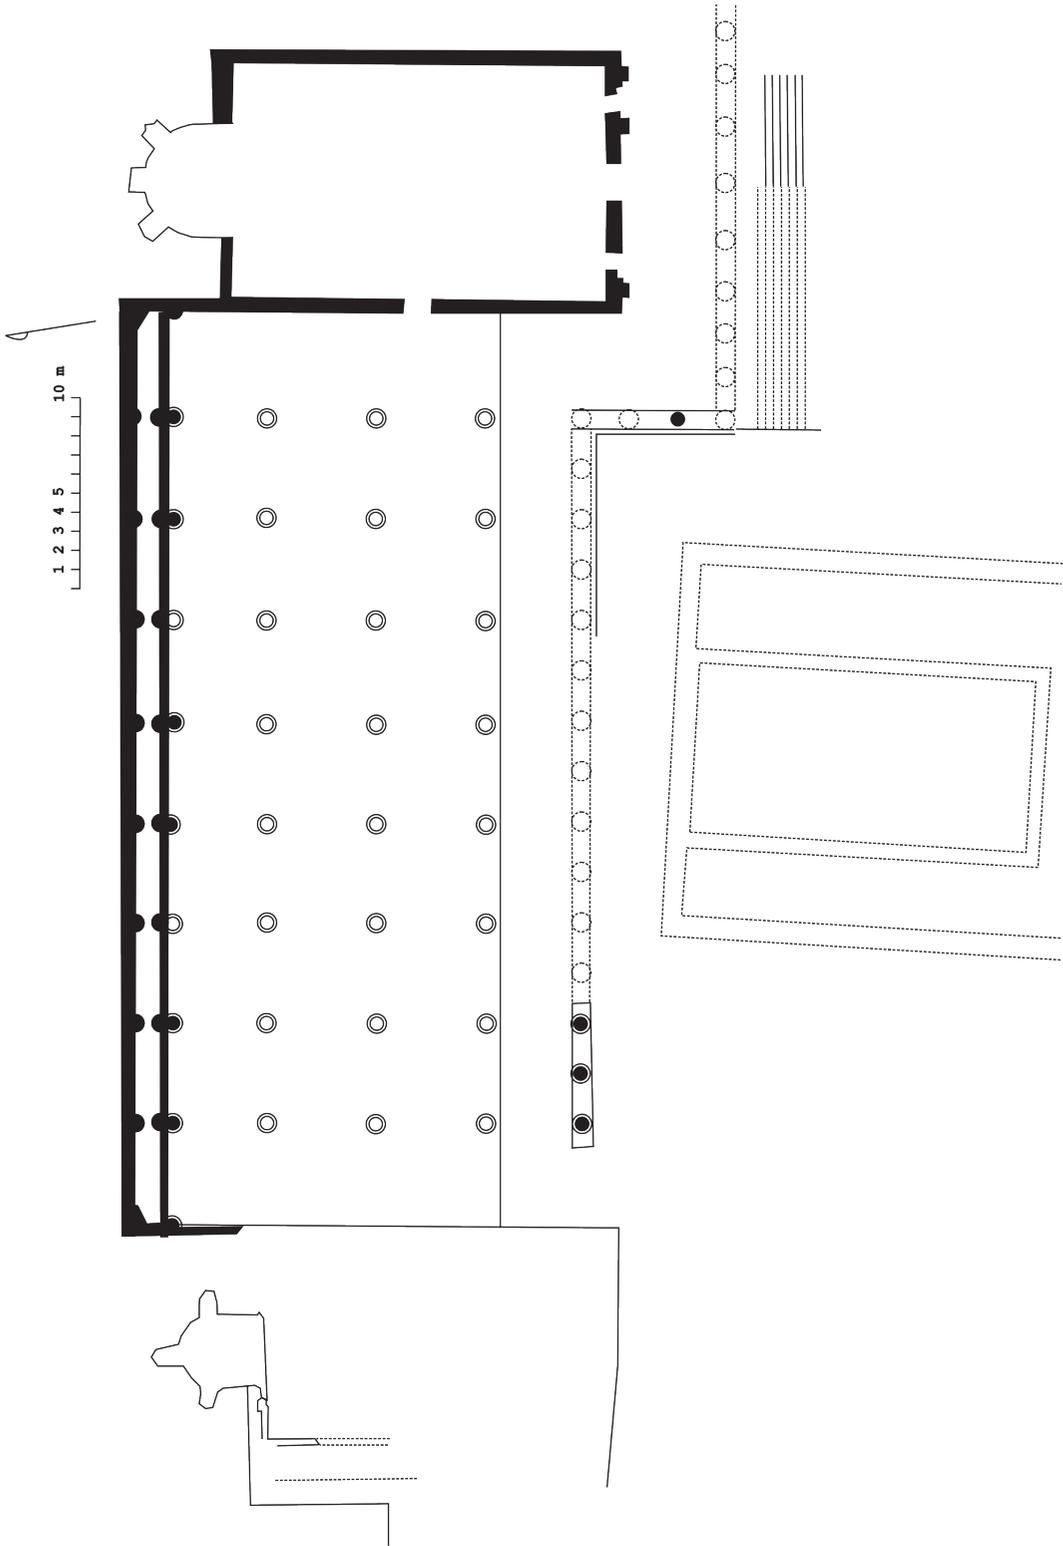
Grundrissrekonstruktion des Forumsbereichs Paestrina, Zeichnung: J. Hollaender
